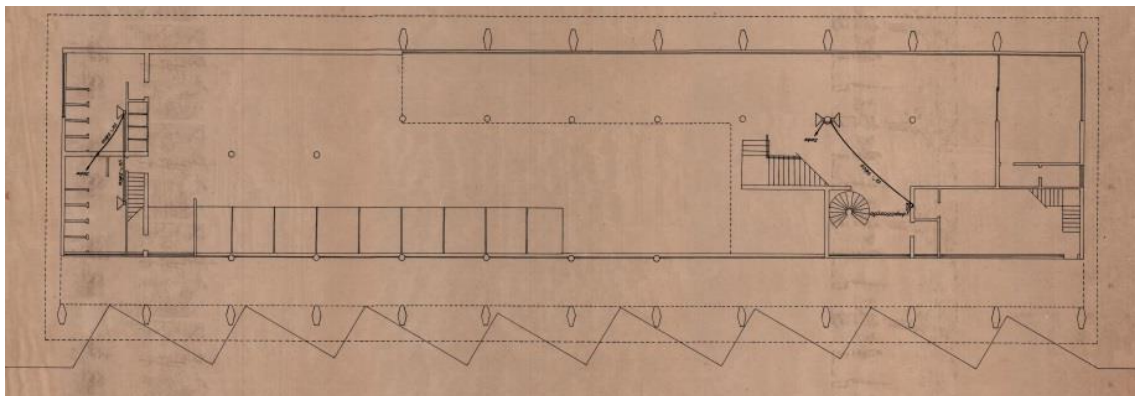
1952 / Planta do pavimento térreo do Terminal Rodoviário Luís Garcia. ©DER.
